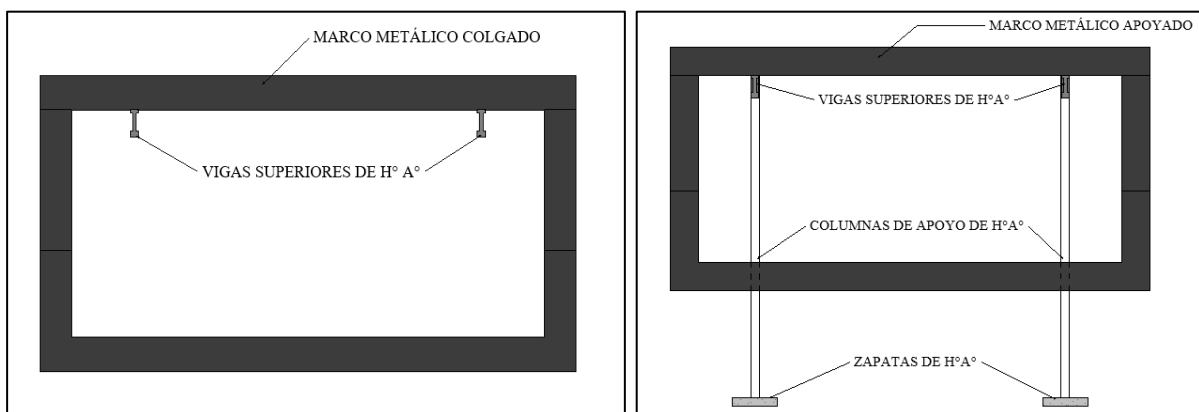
Esquema estructural de marcos metálicos. Fuente: Autor.
